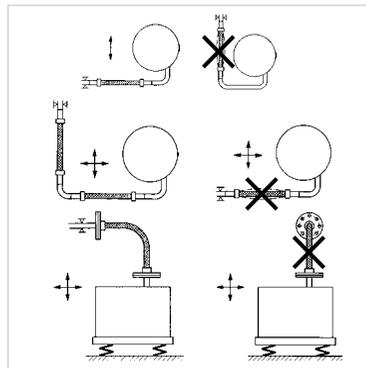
Installation en position adaptée (partie gauche de l'illustration) et inadaptée (partie droite) de conduites flexibles pour l'absorption de vibrations
